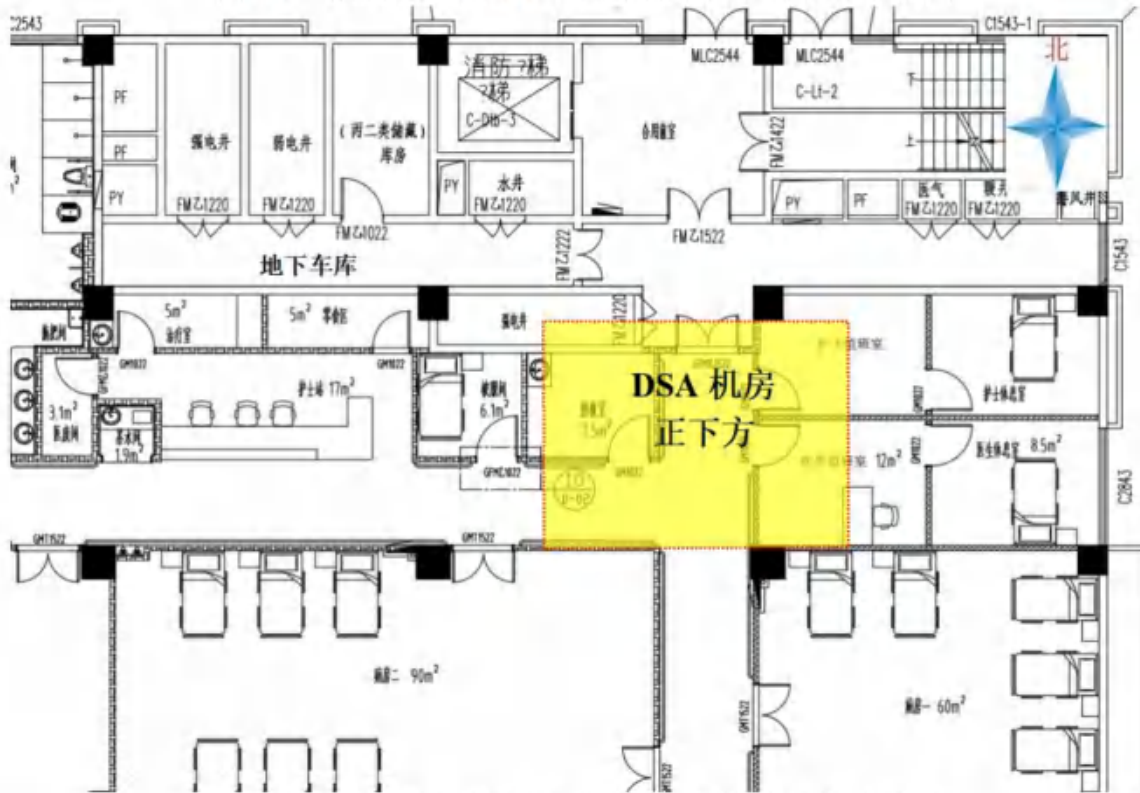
病房楼 2 楼 DSA 机房正下方平面布局示意图
